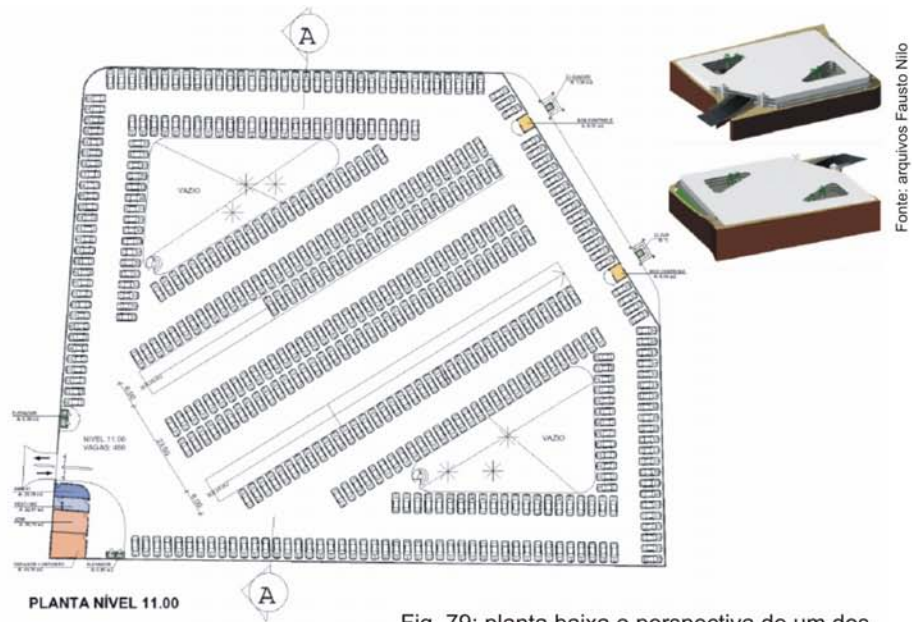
planta baixa e perspectiva de um dos estacionamentos propostos pelo projeto do CMEF
